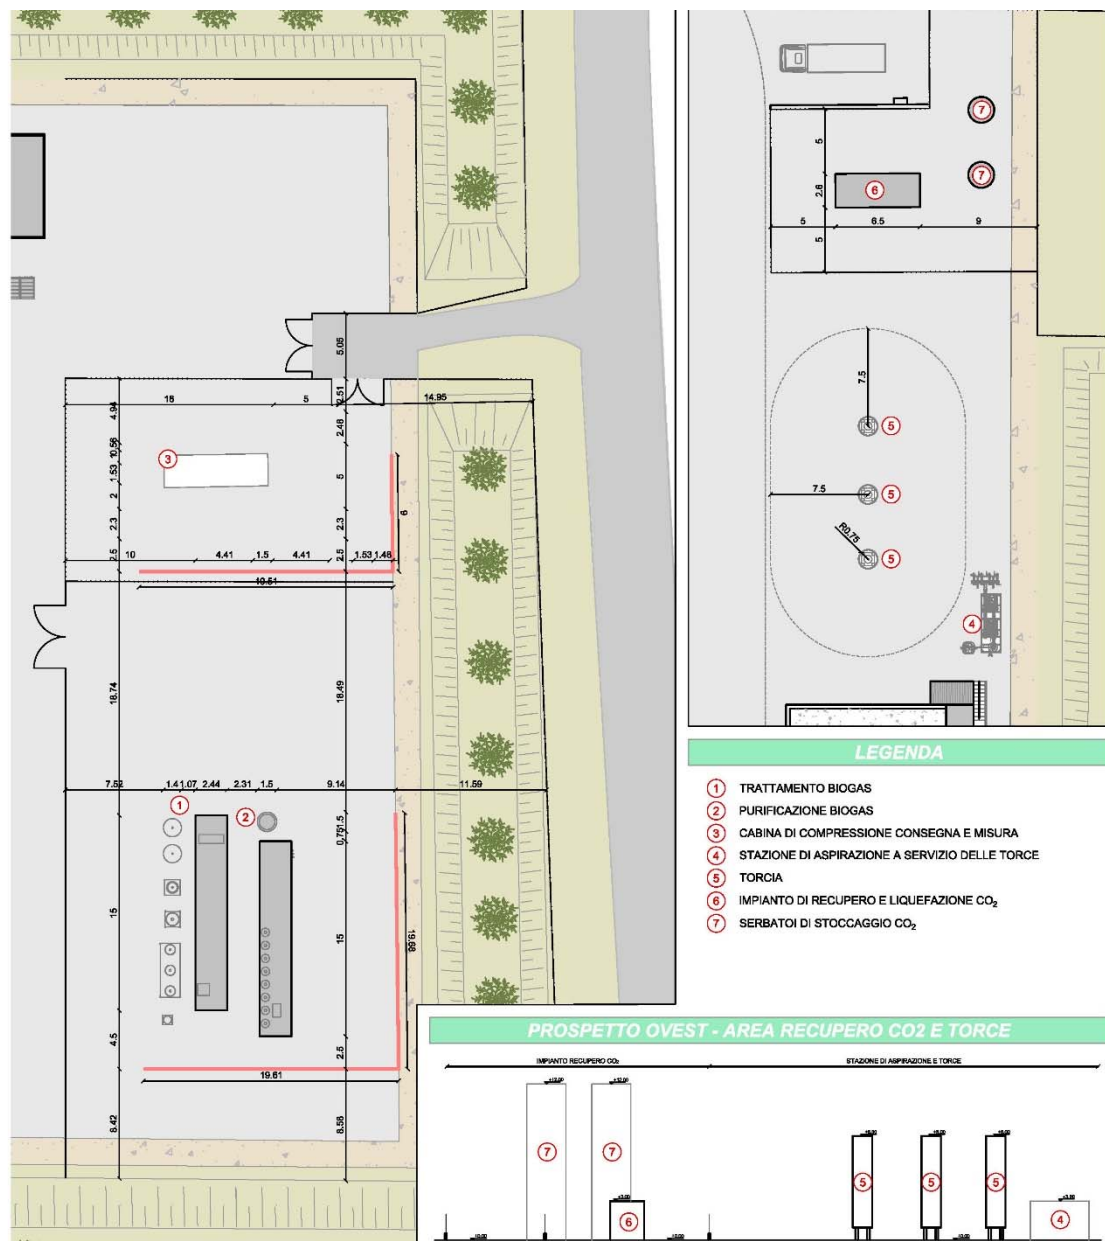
Piante zona upgrading (a sinistra), sistema di trattamento offgas (a destra) e prospetto area recupero CO₂
